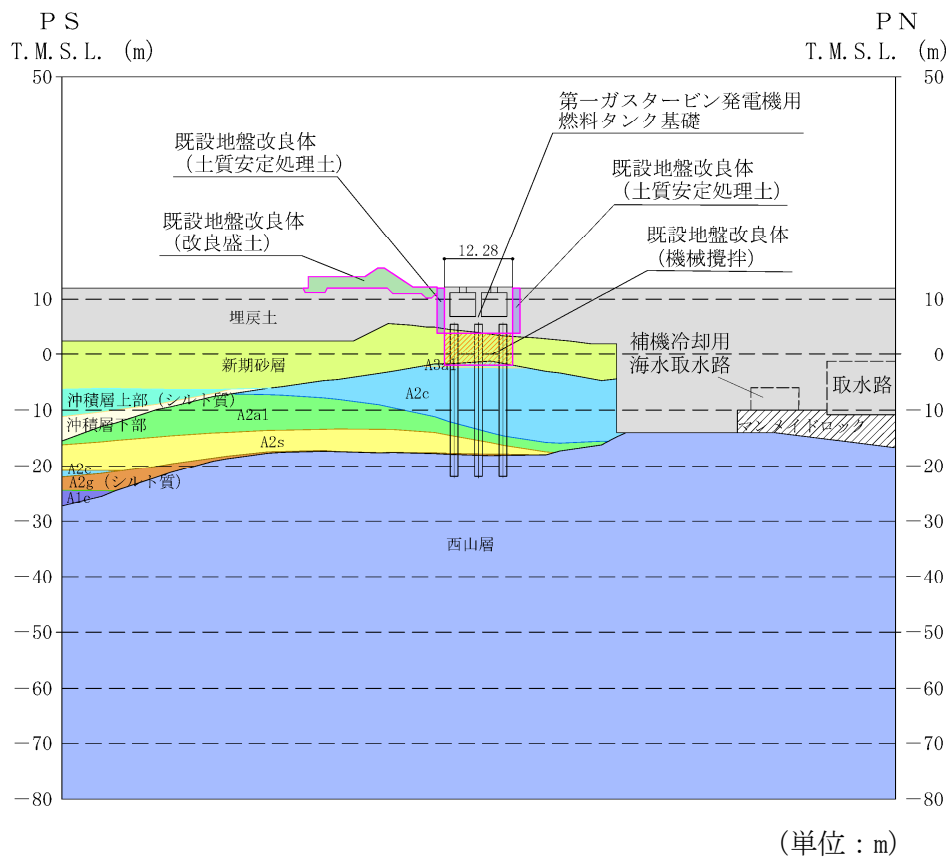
(3) 常設代替交流電源設備基礎断面図 (C-C 断面)
